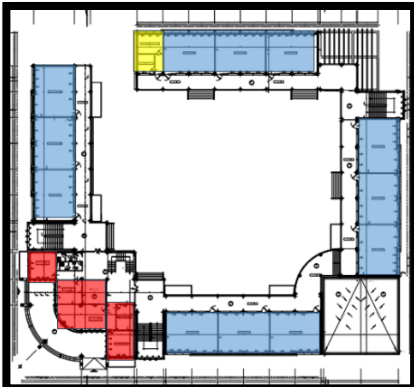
PLAN DU PREMIER ETAGE NIV ; +04.08 ECHELLE :1/50
